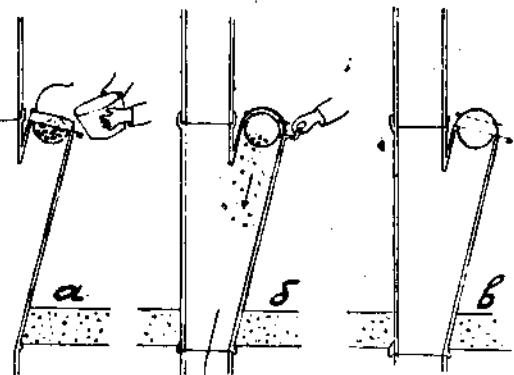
Загрузочный клапан, получивший премию на конкурсе о-ва „Cement Marketing Company: а) крышка открыта и отбросы сбрасываются в приемник, б) крышка закрыта и приемник опрокидывается, в) клапан закрыт
